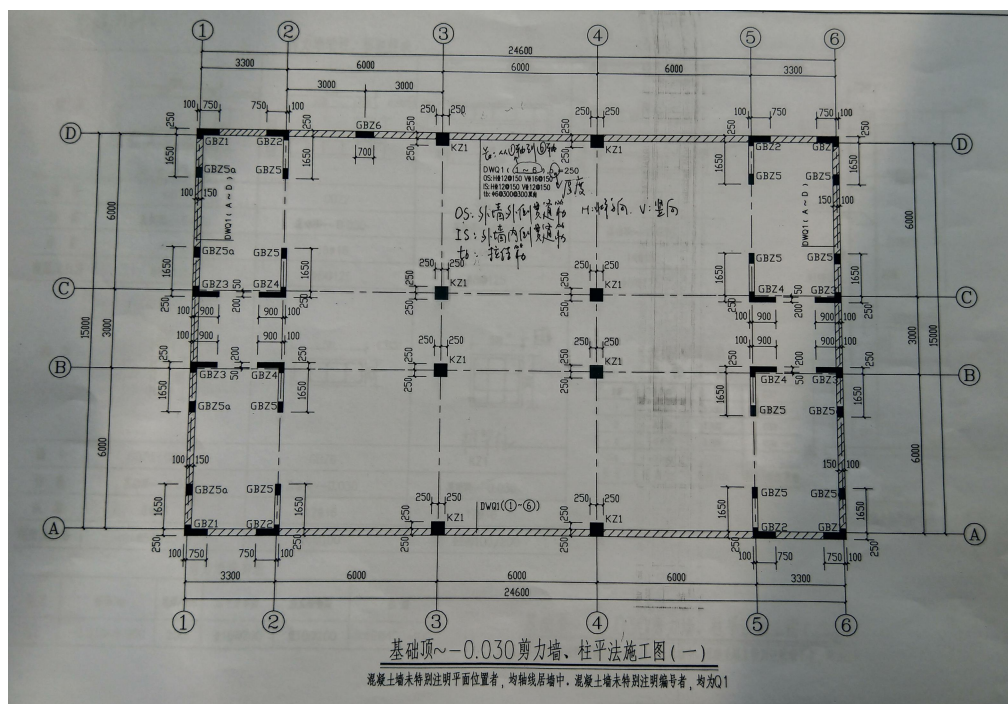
基础顶~-0.030 剪力墙、柱平法施工图(一)
